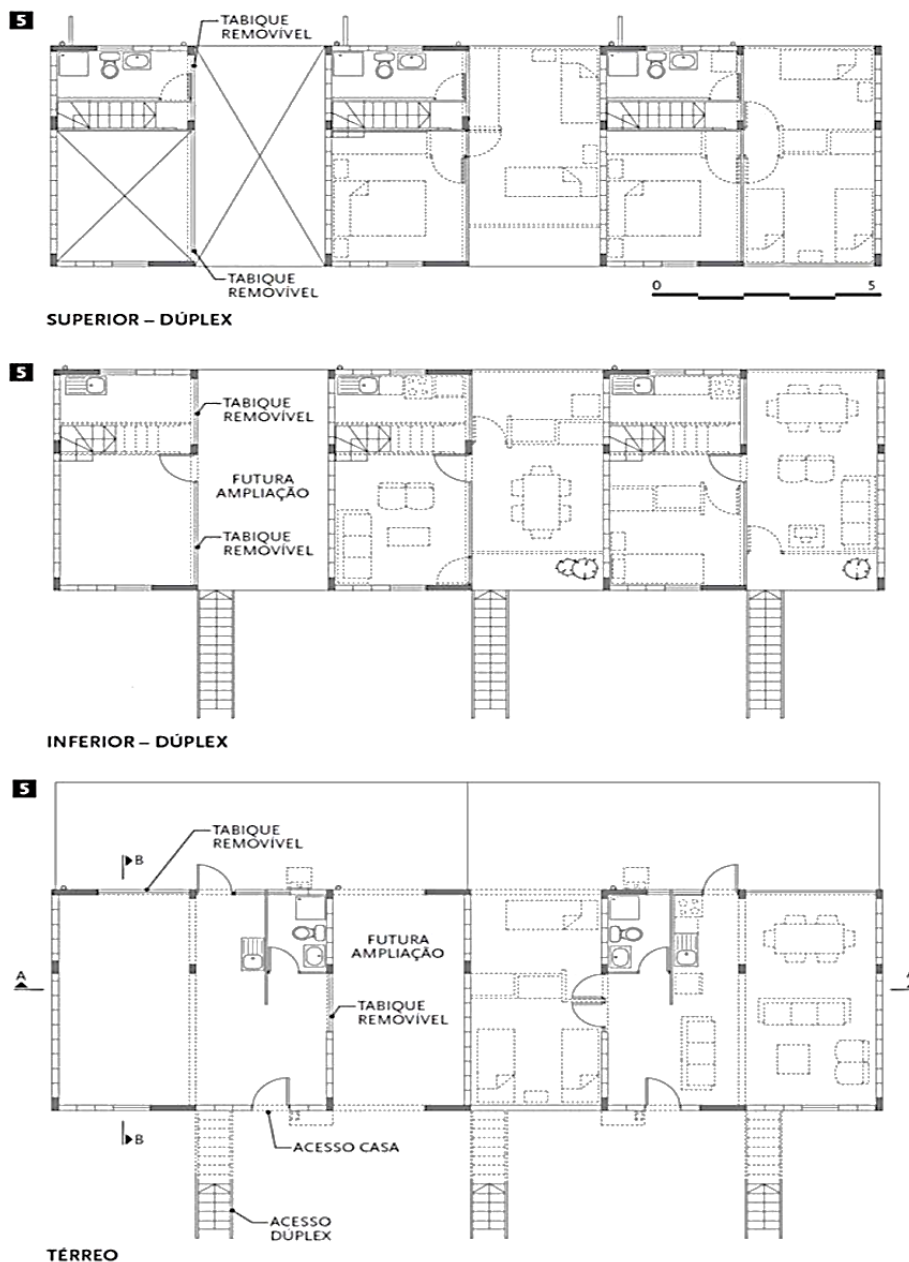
Planta Baixa da Quinta Monroy, Chile (Fonte: Archdaily)
